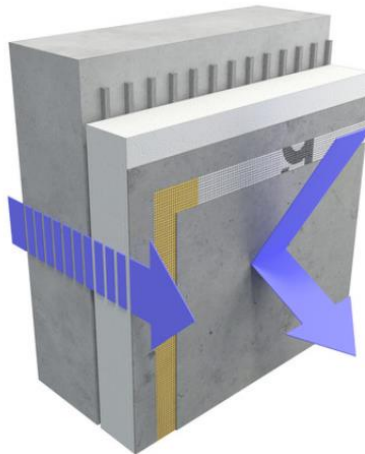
Fijación material aislante con y sin refuerzo (Franco, 2018).
